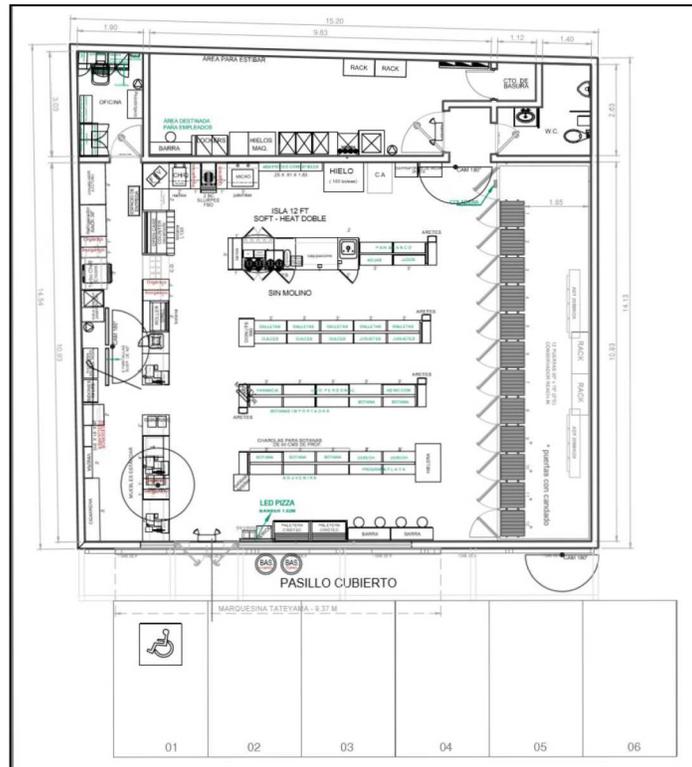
Extracto del plano de conjunto del proyecto, donde se observa la planta arquitectónica.
